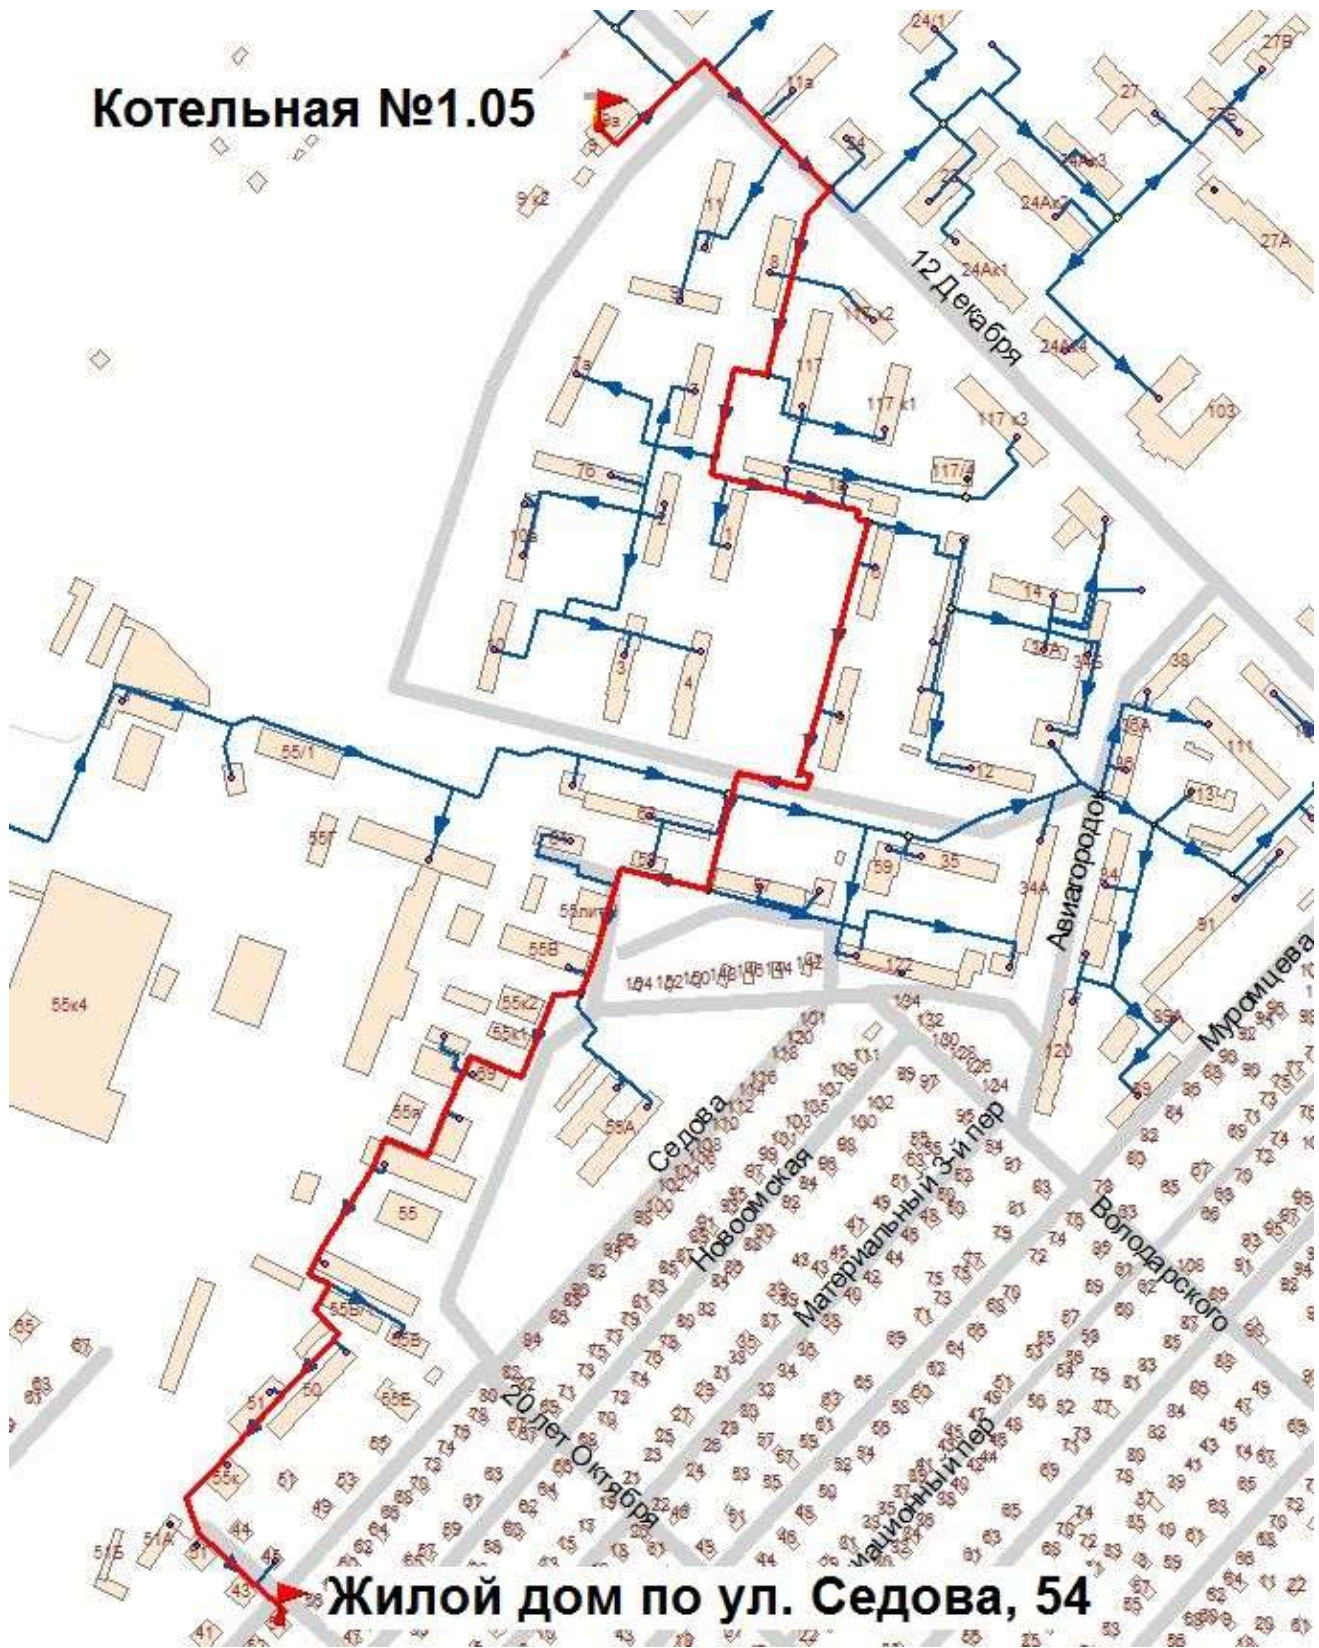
Трассировка теплопровода от Котельной 1.05 до жилого дома по ул. Седова, 54
